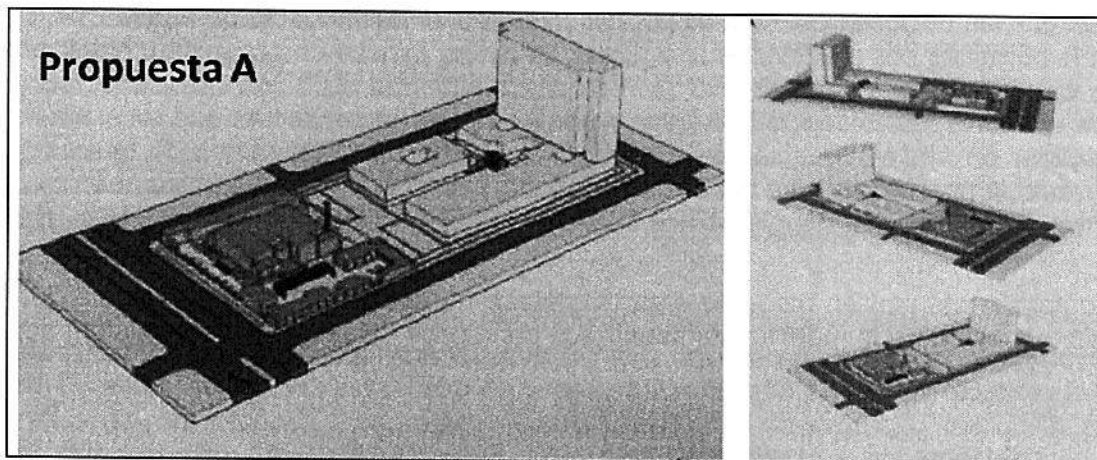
Vistas generales de la propuesta A, fuente: Consorcio Diseñar, DSB Arquitectos, 2017.
